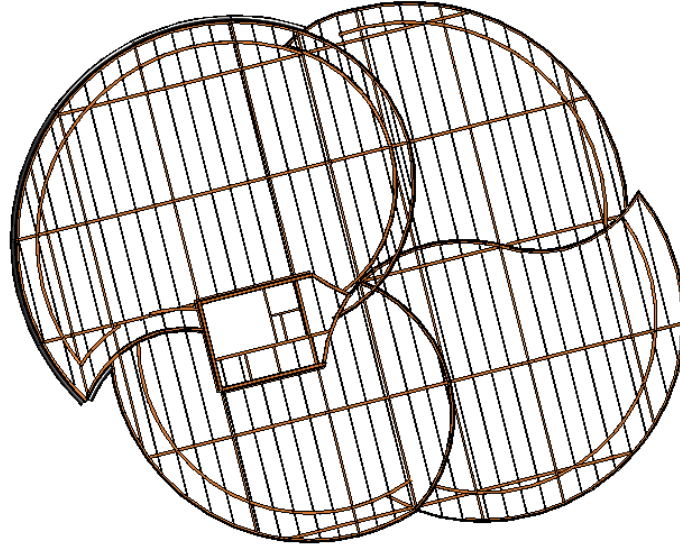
, 9. 3D y forjado estructural PI. Cubierta
